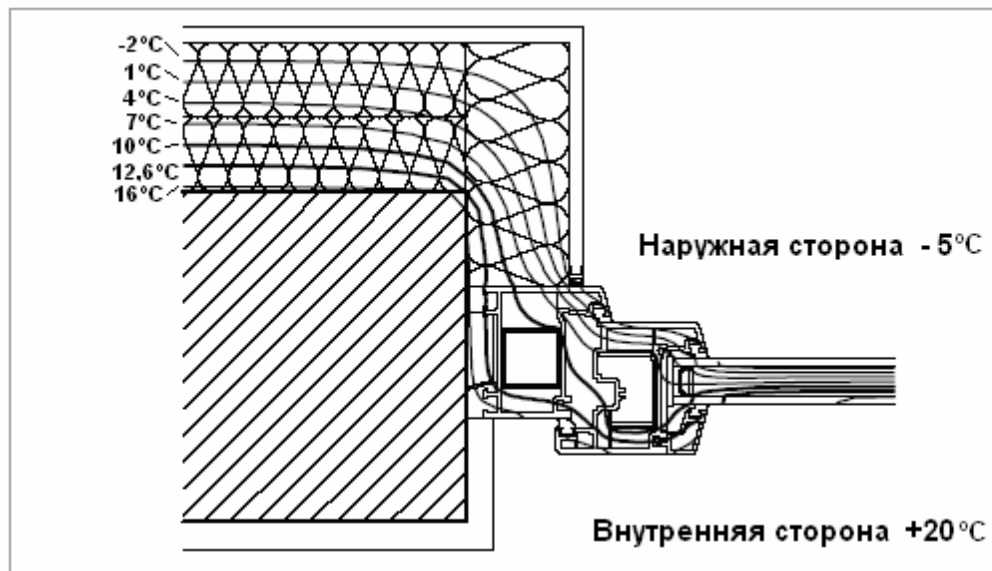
Бетонная стена с наружной изоляцией. Окно из профиля ПВХ, монтаж посередине, изоляция рамы.
